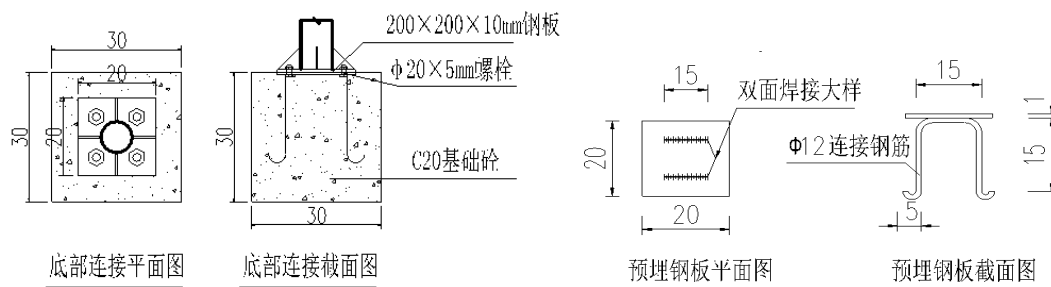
钢筋棚钢管立柱底部钢板与预埋钢板连接大样图
